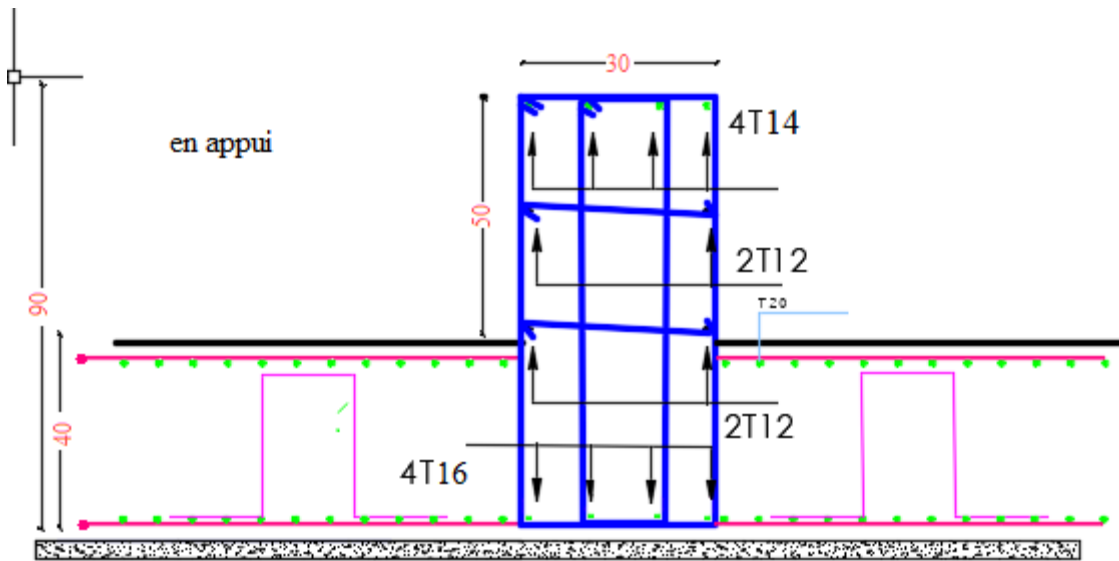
Schéma du ferrailage des nervures secondaires
